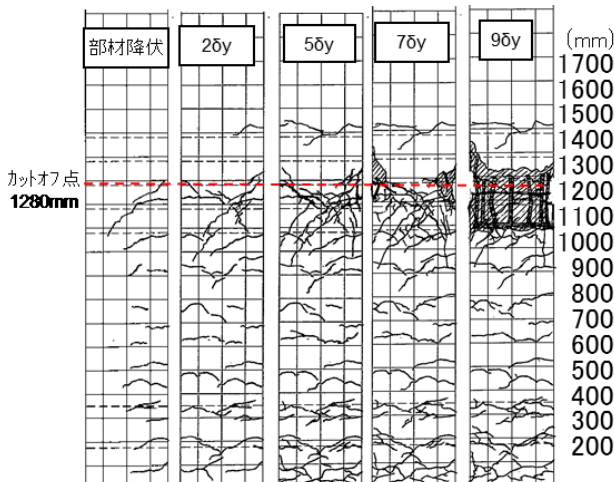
主な荷重ステップのひび割れ状況 (D-12)
